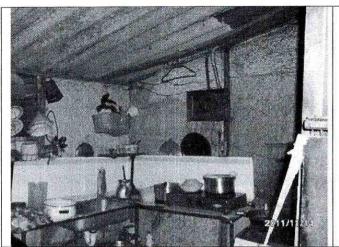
y 2. Vista al interior del predio, donde se evidencia el tipo de construcción utilizado y las deficiencias constructivas en cuanto a la carencia de obras de estabilización y obras de drenaje.
